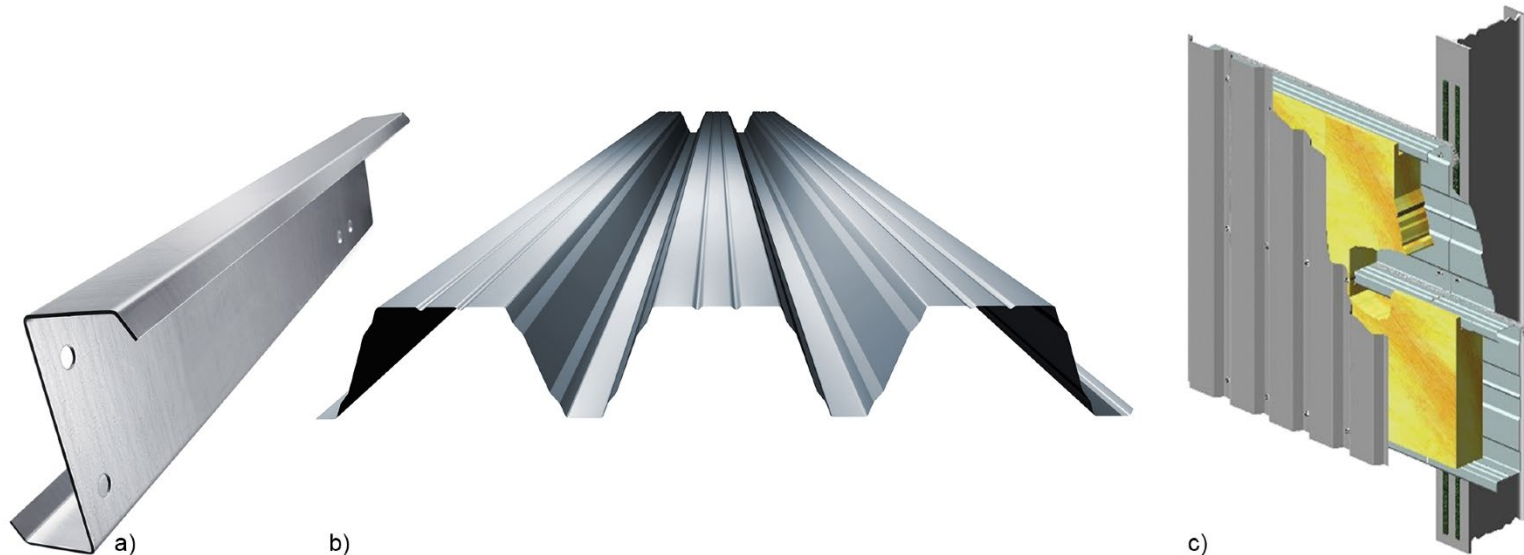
Produkte nach EN 1090-4 und -5: a) tragendes Bauteil, b) tragende Profiltafel, c) Tragwerk
